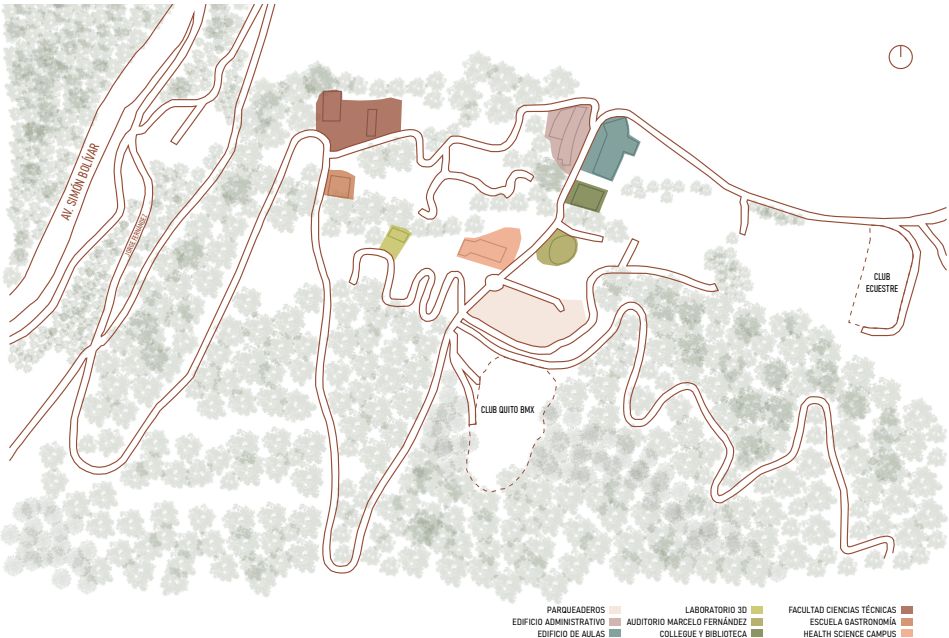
Planta esquemática distribución de espacios en la UIDE
